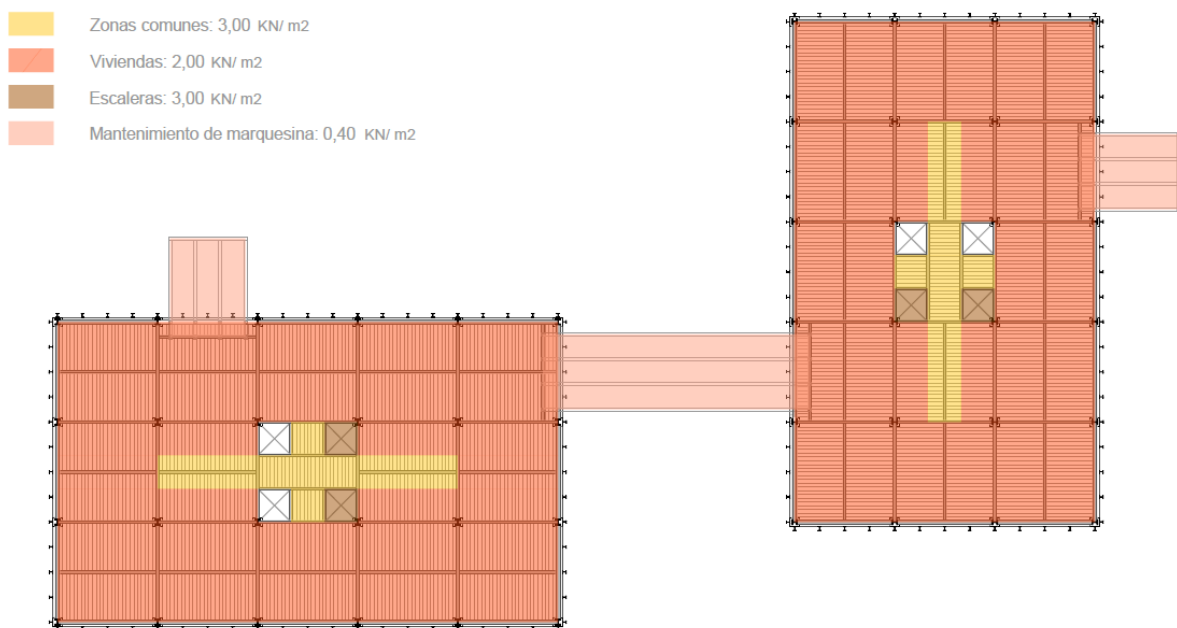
Acciones variables: Sobrecarga de uso en forjado de planta baja. Escala 1:500
